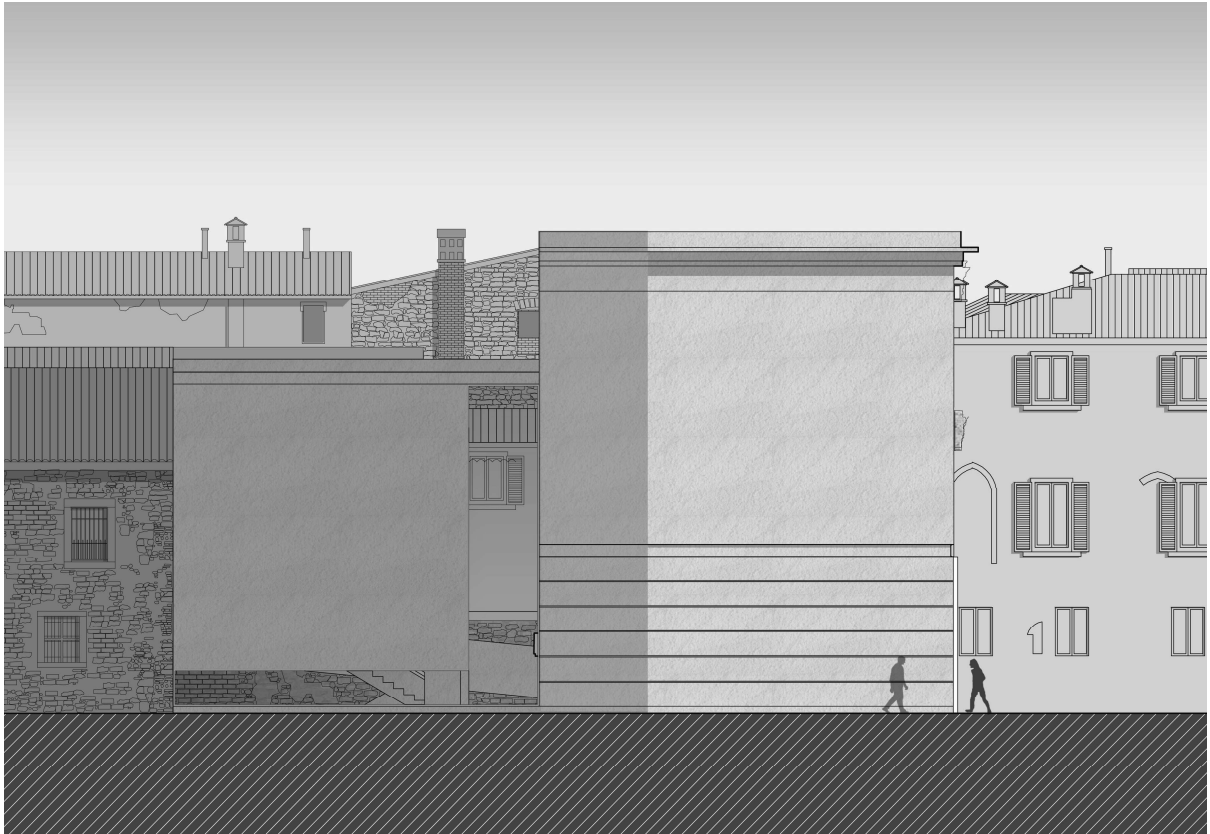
Prospetto nord dell’edificio di Progetto in Piazza Foro
